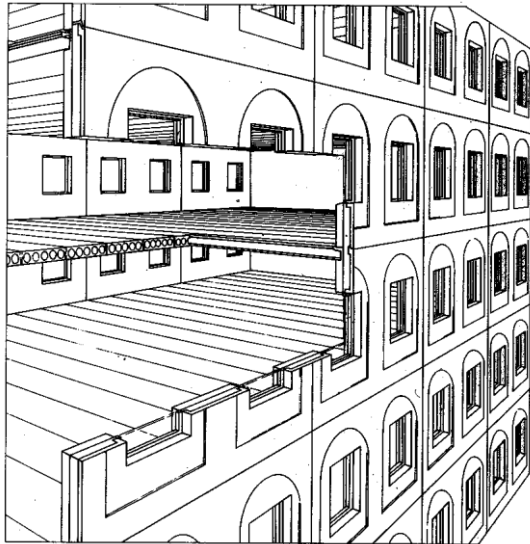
Schéma d'un bâtiment avec façades portantes et grandes portées de plancher
